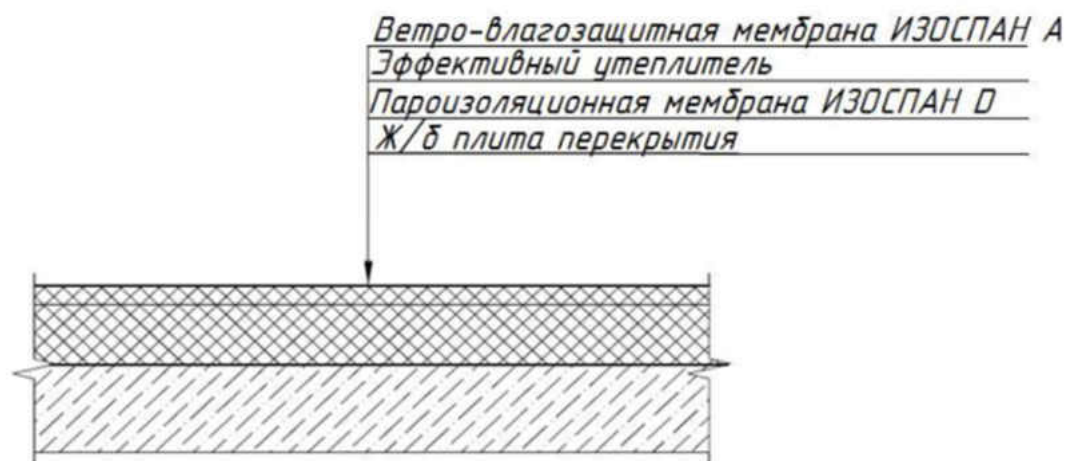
Утепление чердачного перекрытия железобетонного (плоские плиты)
